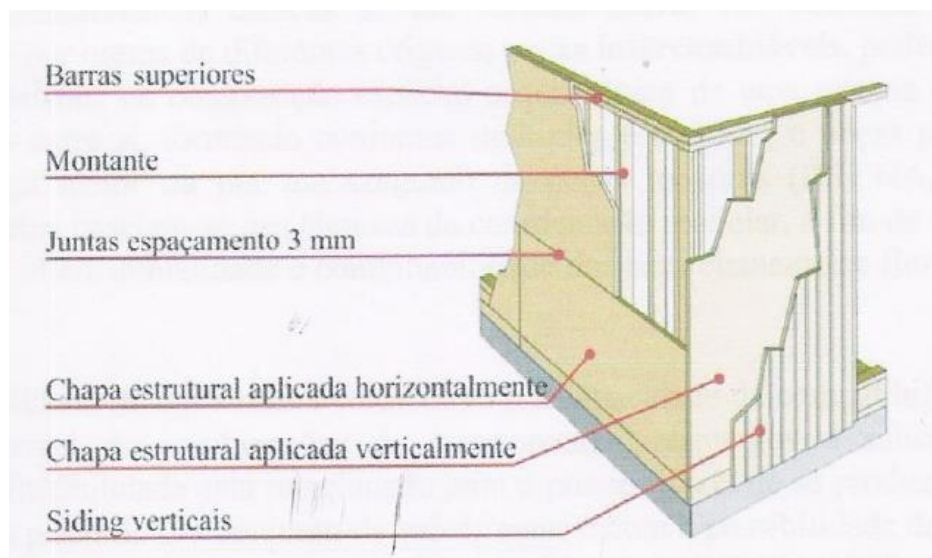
Detalhe da Montagem da Parede em Wood Frame
